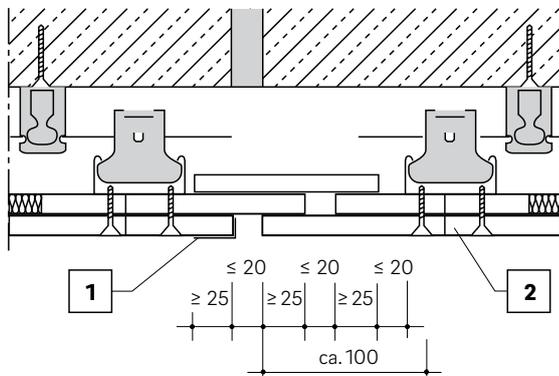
Bewegungsfuge (Angaben in mm)
